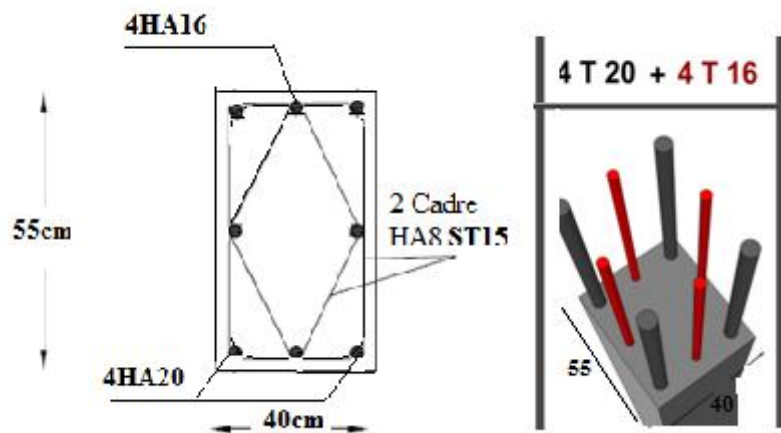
Dispositions des armatures de poteau (40.55) cm<sup>2</sup>.
